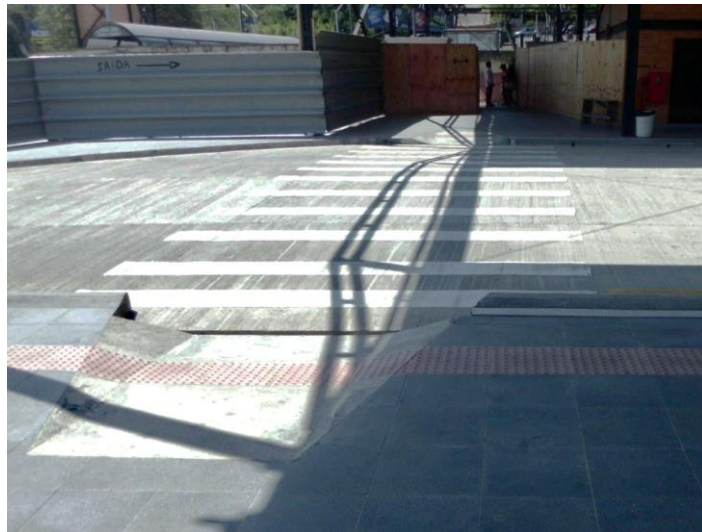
Rebaixamentos das calçadas e faixa de pedestres do terminal
